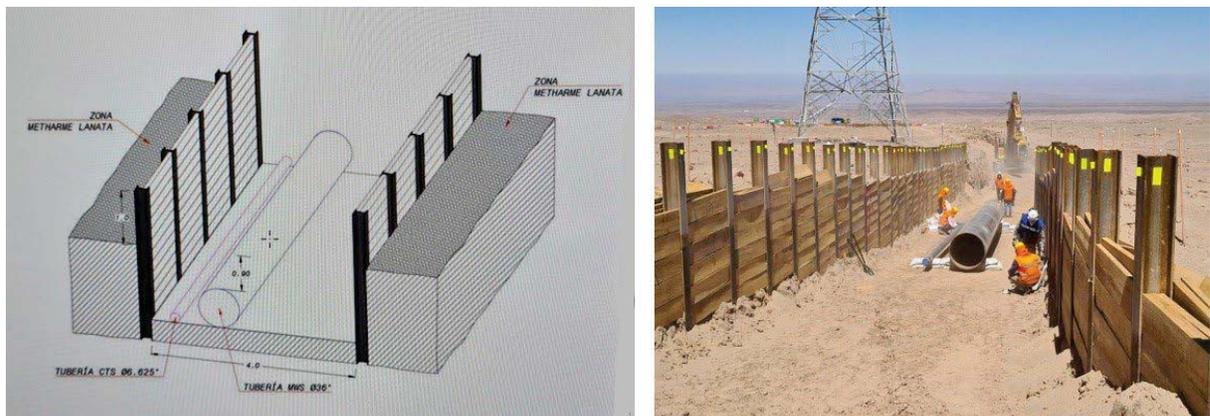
Esquema de método constructivo de “muro berlínés” (izquierda) y “muro berlínés” ya construido en el área (derecha). Fuente: Elaboración propia.
